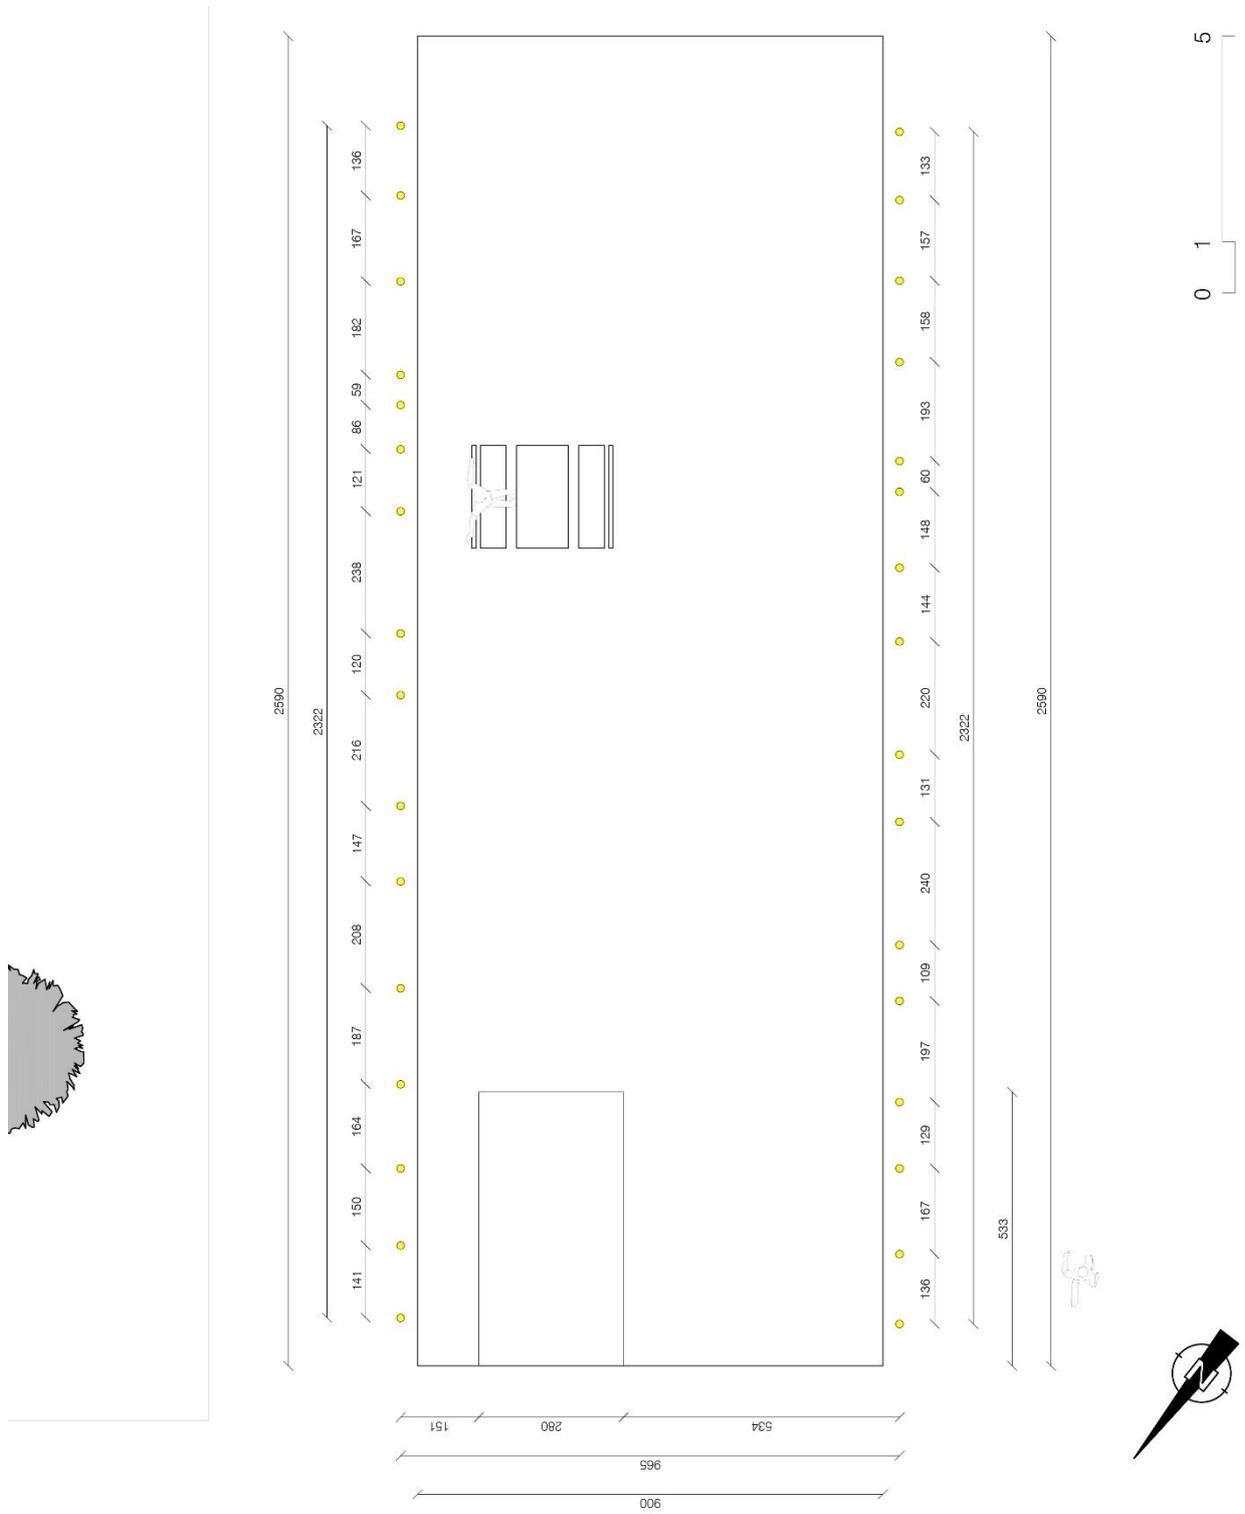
Bauaufnahme, Pergola Grundriss
